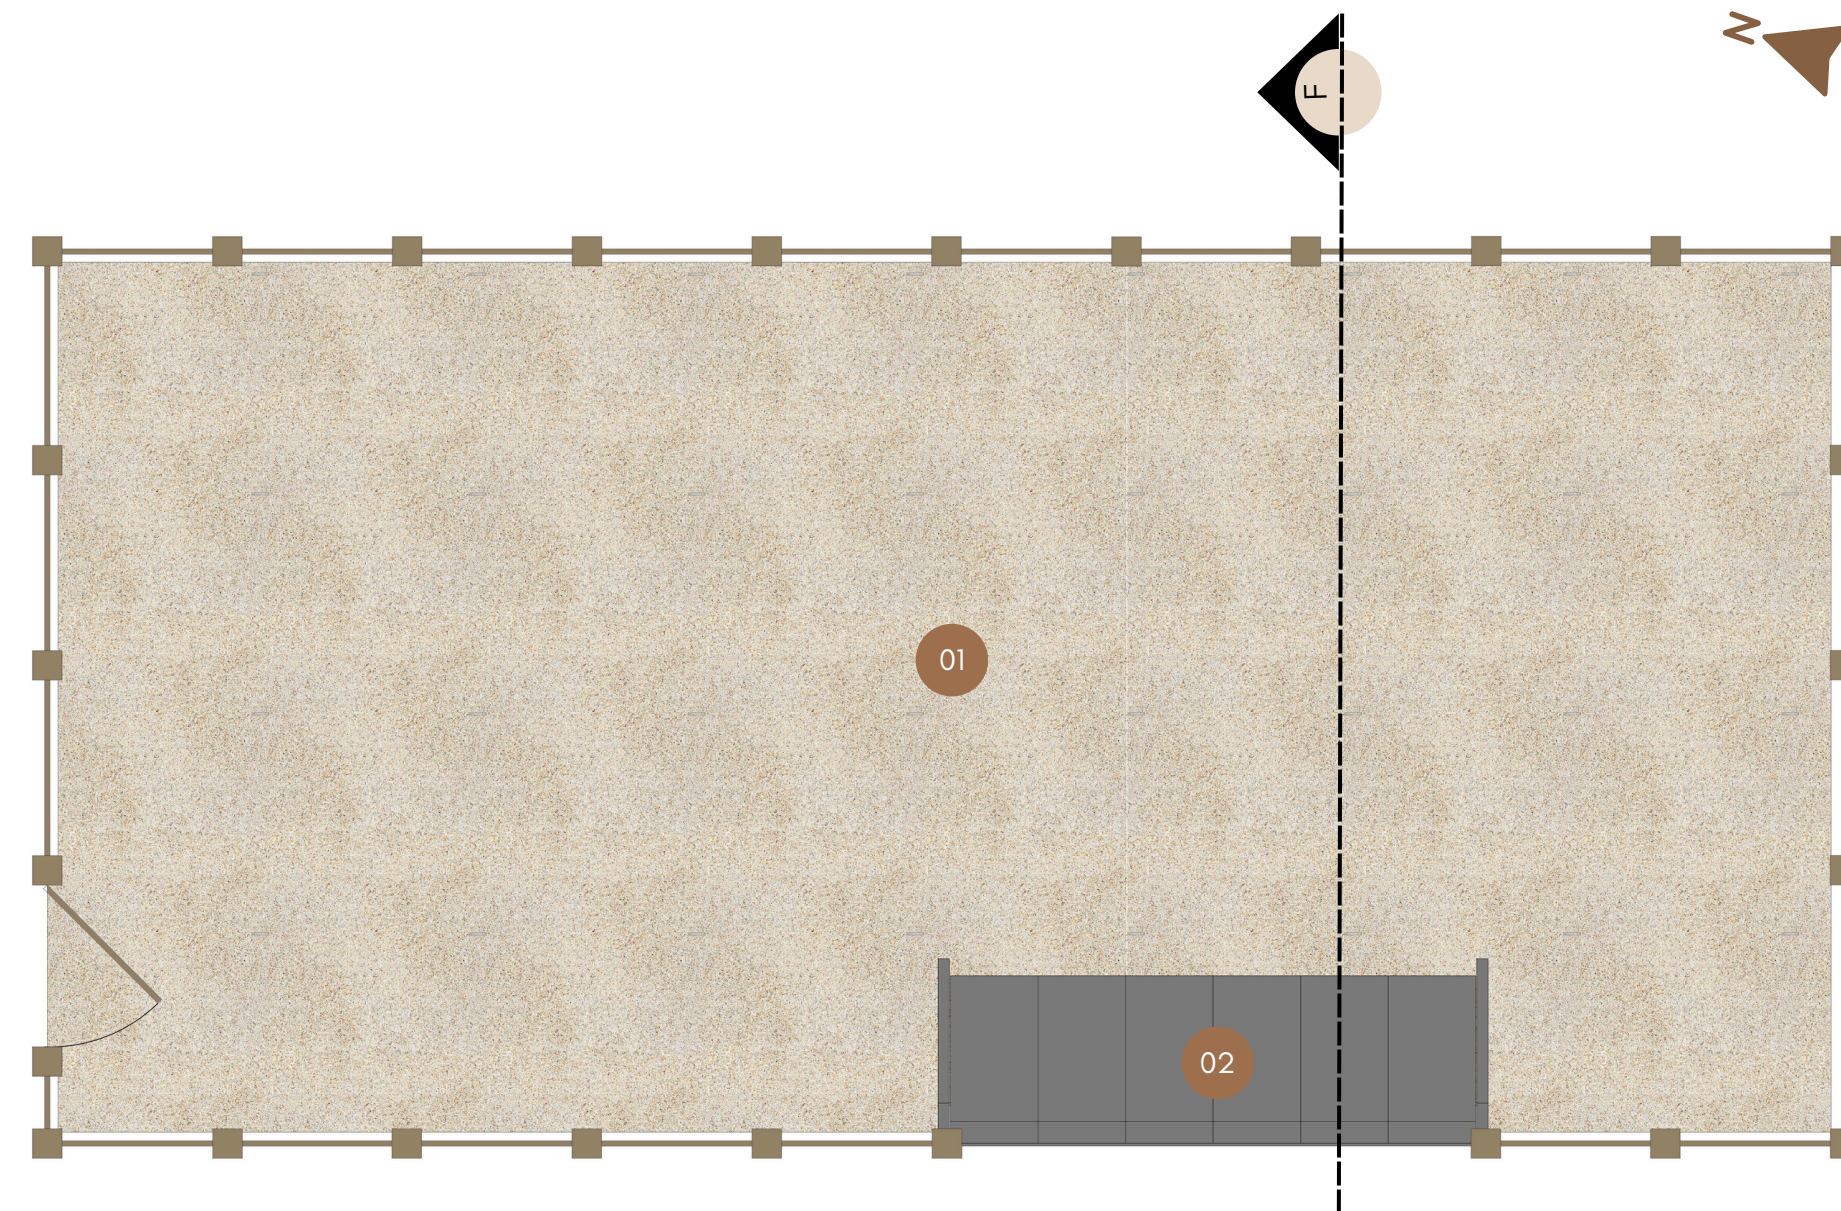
Planta picadeiro aberto / Fonte: Elaborado pela autora em 2024
